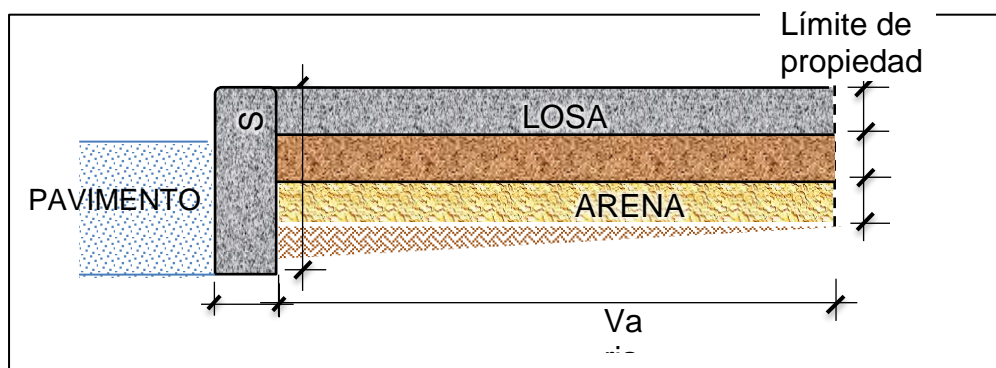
Detalle de vereda adyacente a calzada.
